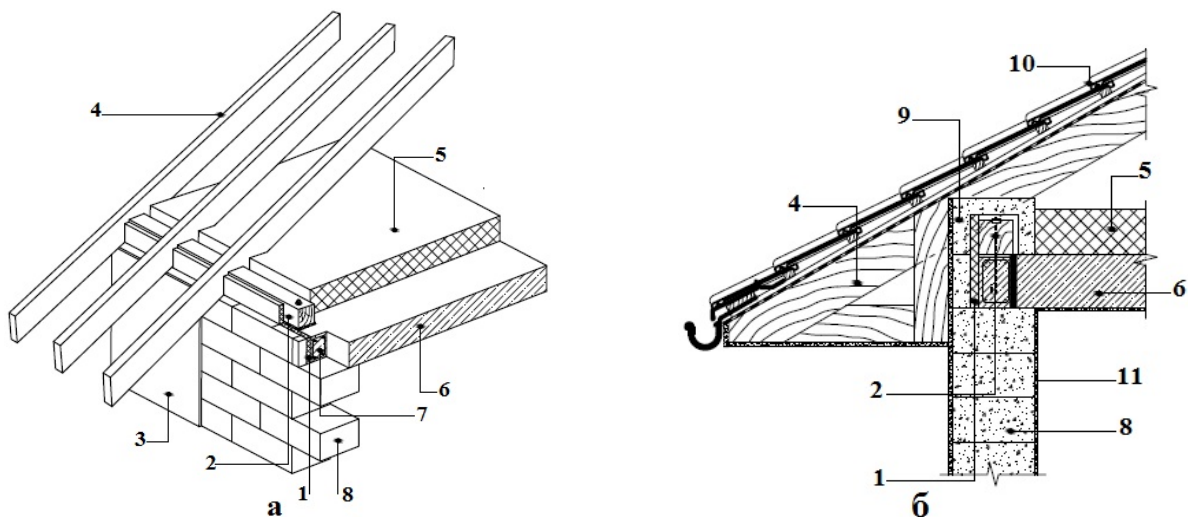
Фрагмент кладки несущей стены из газобетонных блоков и кровельной системы: а — элемент конструкции; б — разрез по стене; 1 — минеральная вата; 2 — мауэрлат по рубероиду заанкеренный к венцу и утепленный минеральной ватой; 3 — наружная отделка; 4 — стропила; 5 — изоляция из минеральной ваты; 6 — монолитное железобетонное перекрытие или сборно-монолитное; 7 — железобетонный пояс; 8 — стена из блоков YTONG; 9 — перевернутые U-образные блоки, накрывающие мауэрлат между стропильными ногами; 10 — черепичная кровля по деревянной обрешетке; 11 — внутренняя отделка
